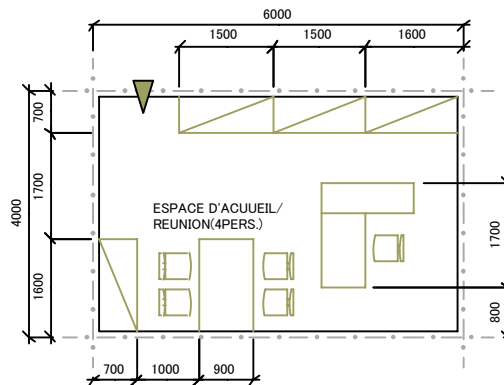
Plan planimétrique du bureau du directeur technique et du secrétaire général du Comité
